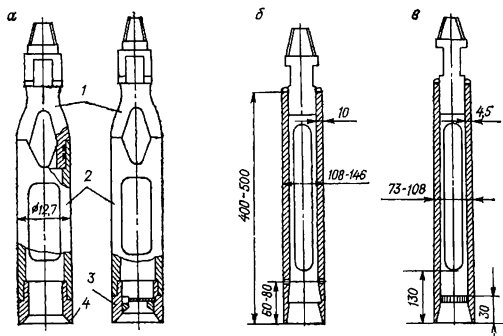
Забивные стаканы: а — к установке УПБ-15М; б — для бурения полускальных пород; в — для бурения глинистых пород; 1 — вилка; 2 — корпус; 3 — башмак с клапаном; 4 — башмак без клапана
